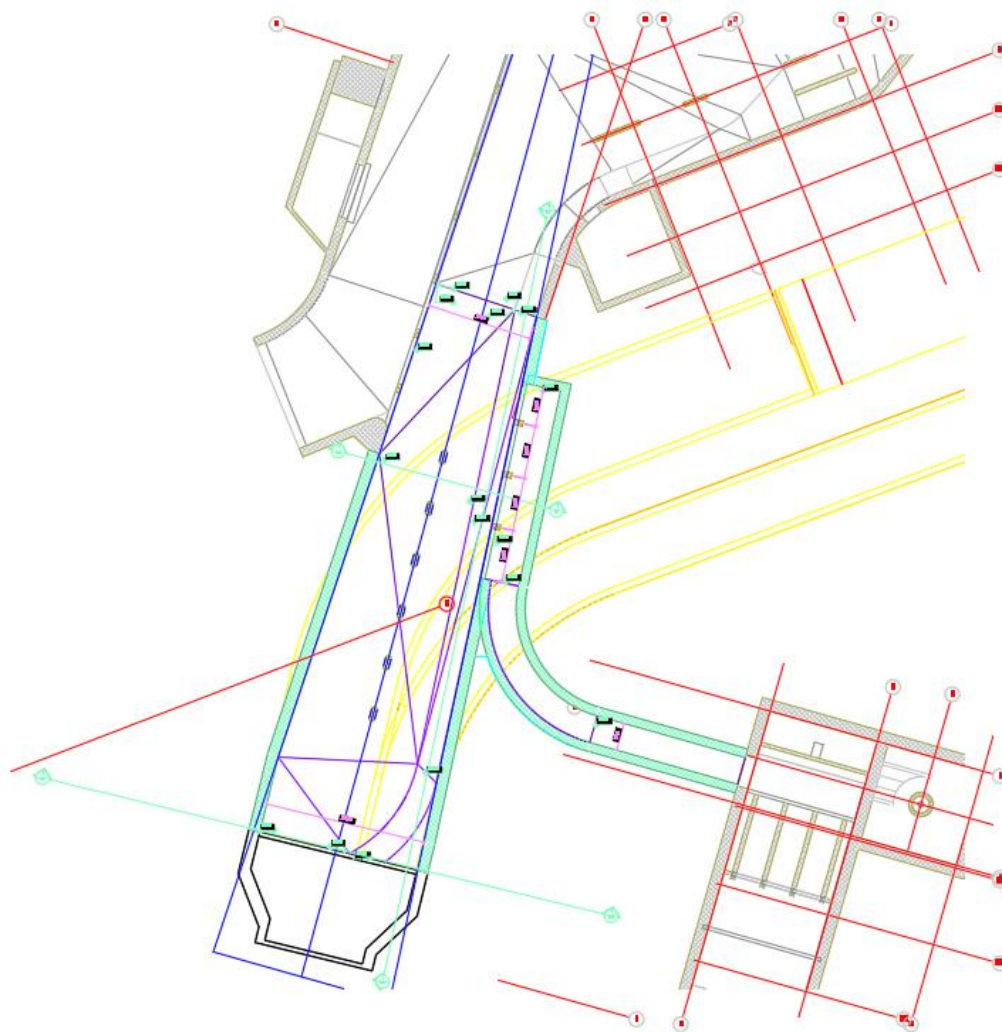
stralcio pianta Hub idrico di Coroglio
